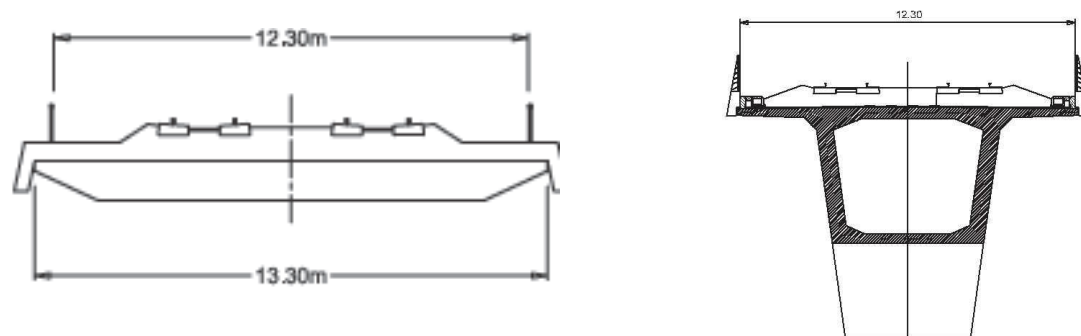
et 16 - Coupe transversale type d'un pont-rail, et coupe transversale type d'un viaduc avec tablier en béton précontraint
